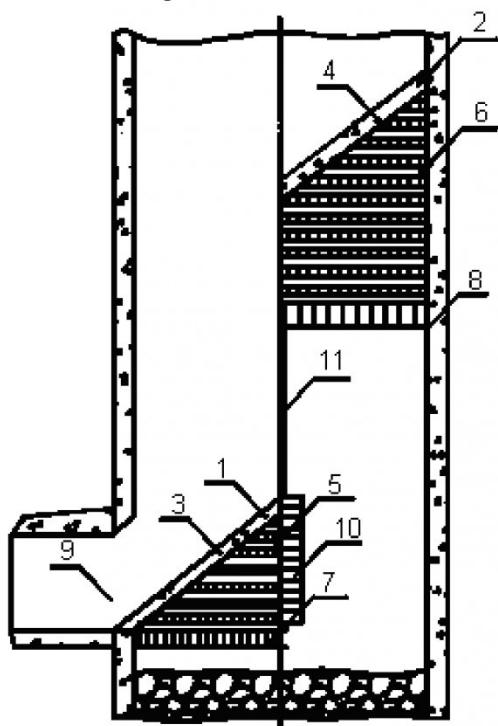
Конструкция предохранительного полка: 1, 2 - наклонная отражательная стенка; 3, 4 - распределительно-утяжелительная бетонная плита; 5, 6 - амортизирующий элемент; 7, 8 - горизонтальные опорные балки; 9 - отбойная ниша; 10 - вертикальная стена состоящая из опорных балок; 11 - разделительная стенка
